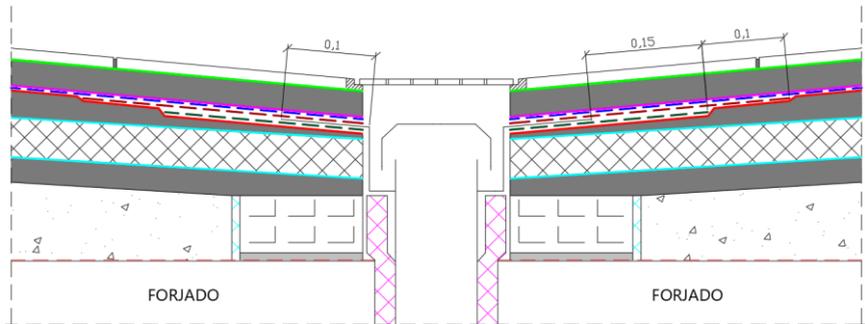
Detalle constructivo cubierta, encuentro con sumidero. (Elaboración propia, 2023).
